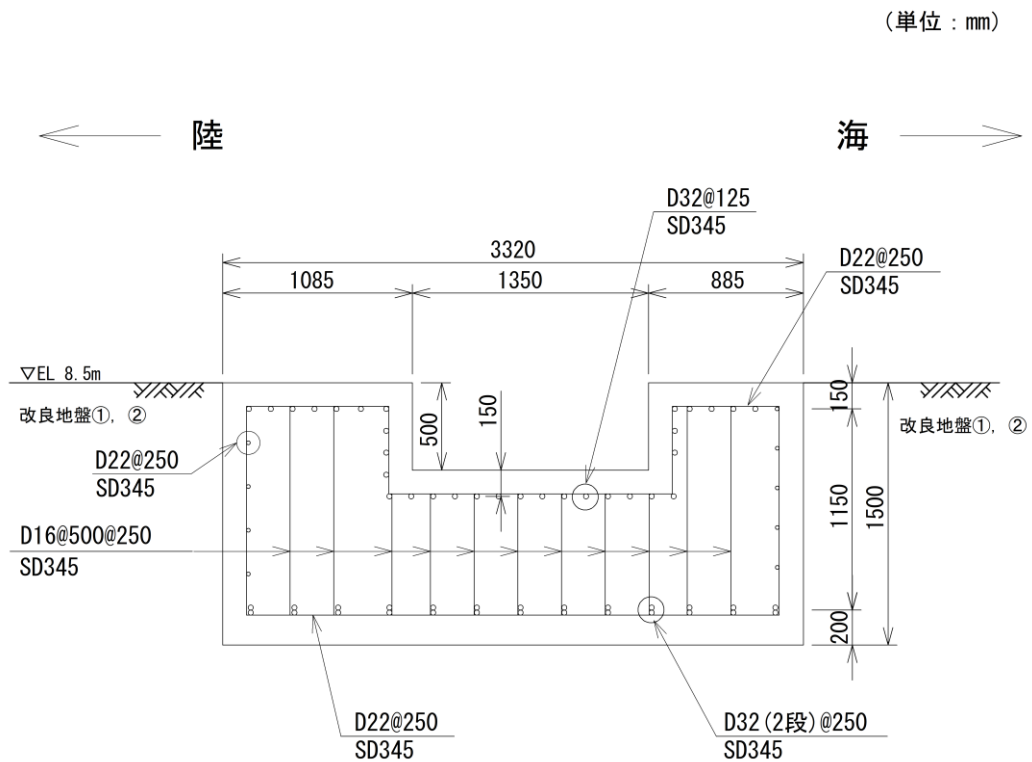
防波扉基礎スラブの概略配筋図 (B-B 断面)
